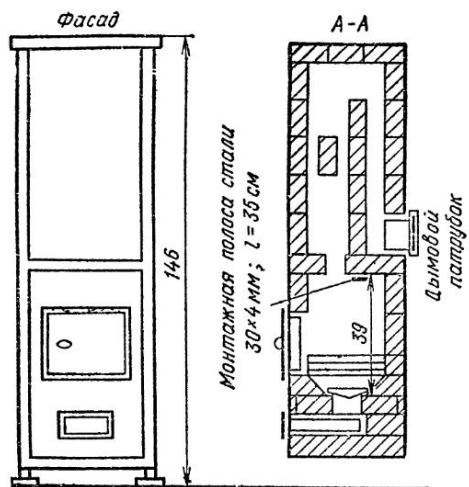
Печь МВМС-61. Фасад и вертикальные разрезы
